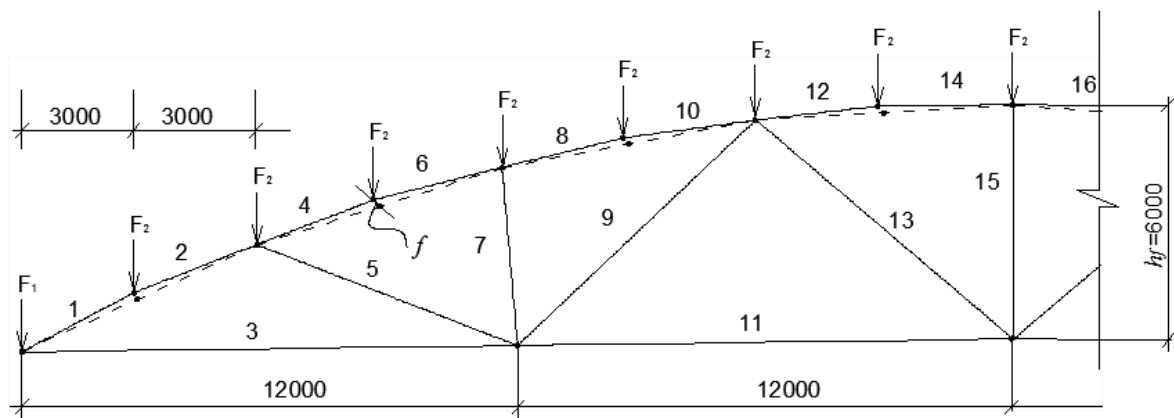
Стальная полигональная ферма с изогнутыми стержнями панели верхнего пояса
